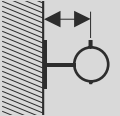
Befestigungsabstände Geberit Mepla Systemrohre ML (Rolle) auf der Rohbetondecke
